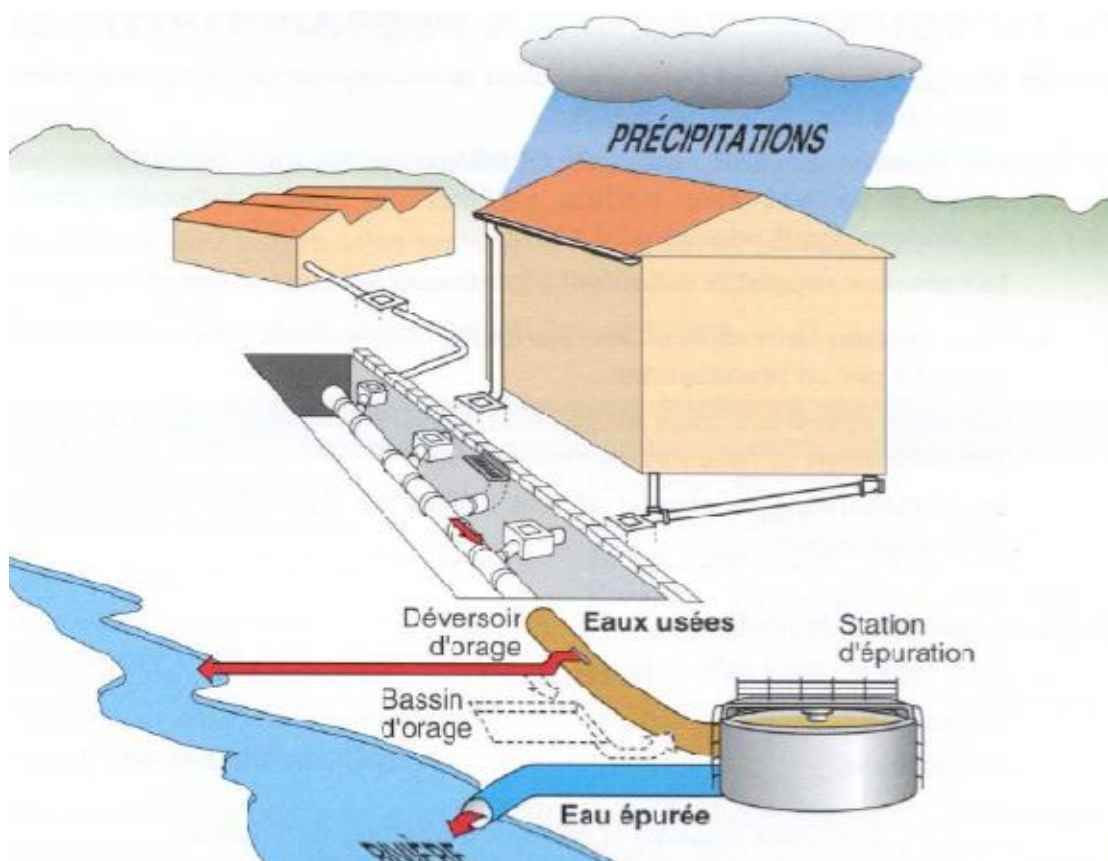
L'implantation du bassin d'orage dans le réseau d'assainissement [30]
